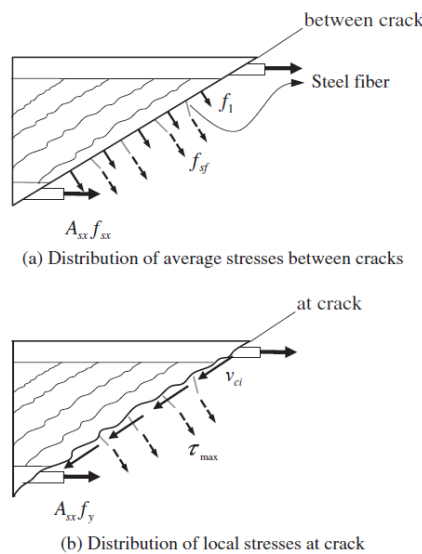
Transmisión de las fuerzas a través de las fisuras [49].
